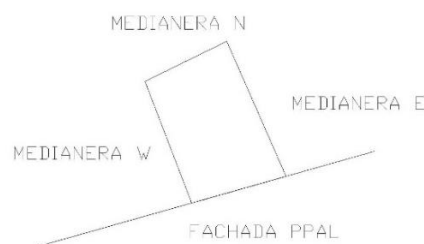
Croquis nomenclatura muros de fachada y medianería. Fuente: Propia a partir de modificación de imagen de Catastro.
